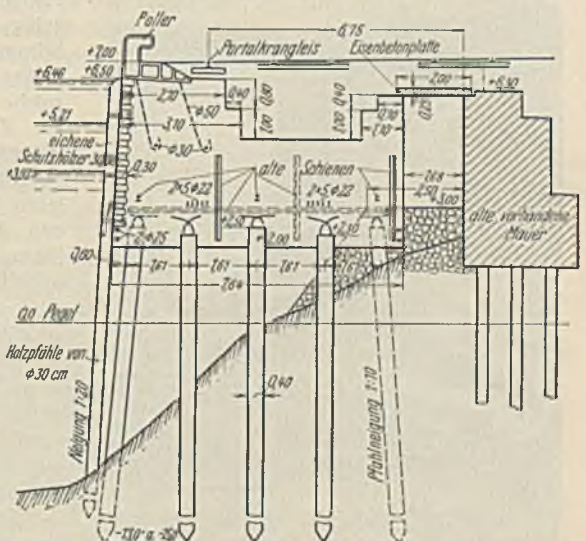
Querschnitt durch die Mittelachse eines Pfeilers und dessen Bewehrung.
